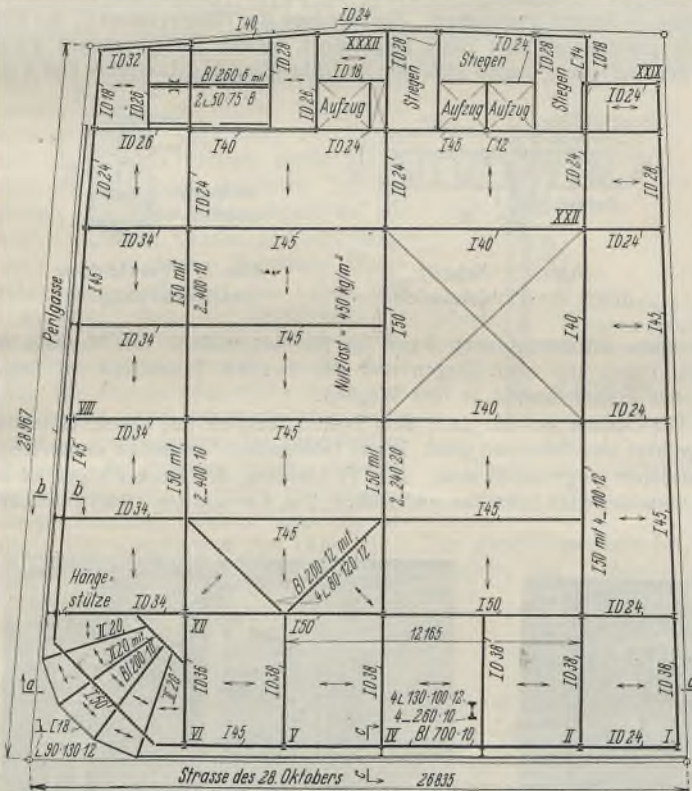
Grundriß und Trägerlage im Zwischengeschöß des Warenhauses.
